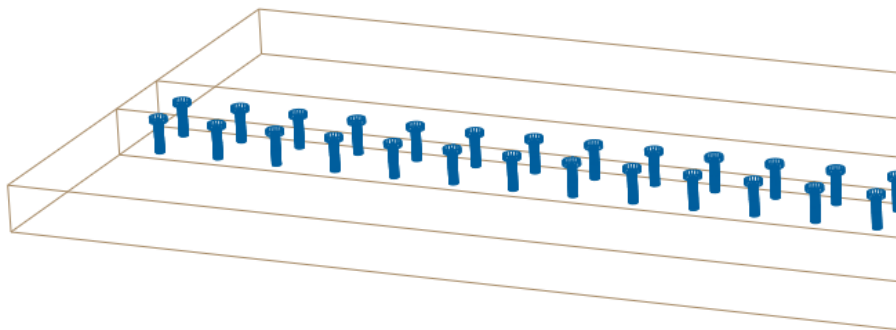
Interação entre laje de concreto e conectores de cisalhamento.
